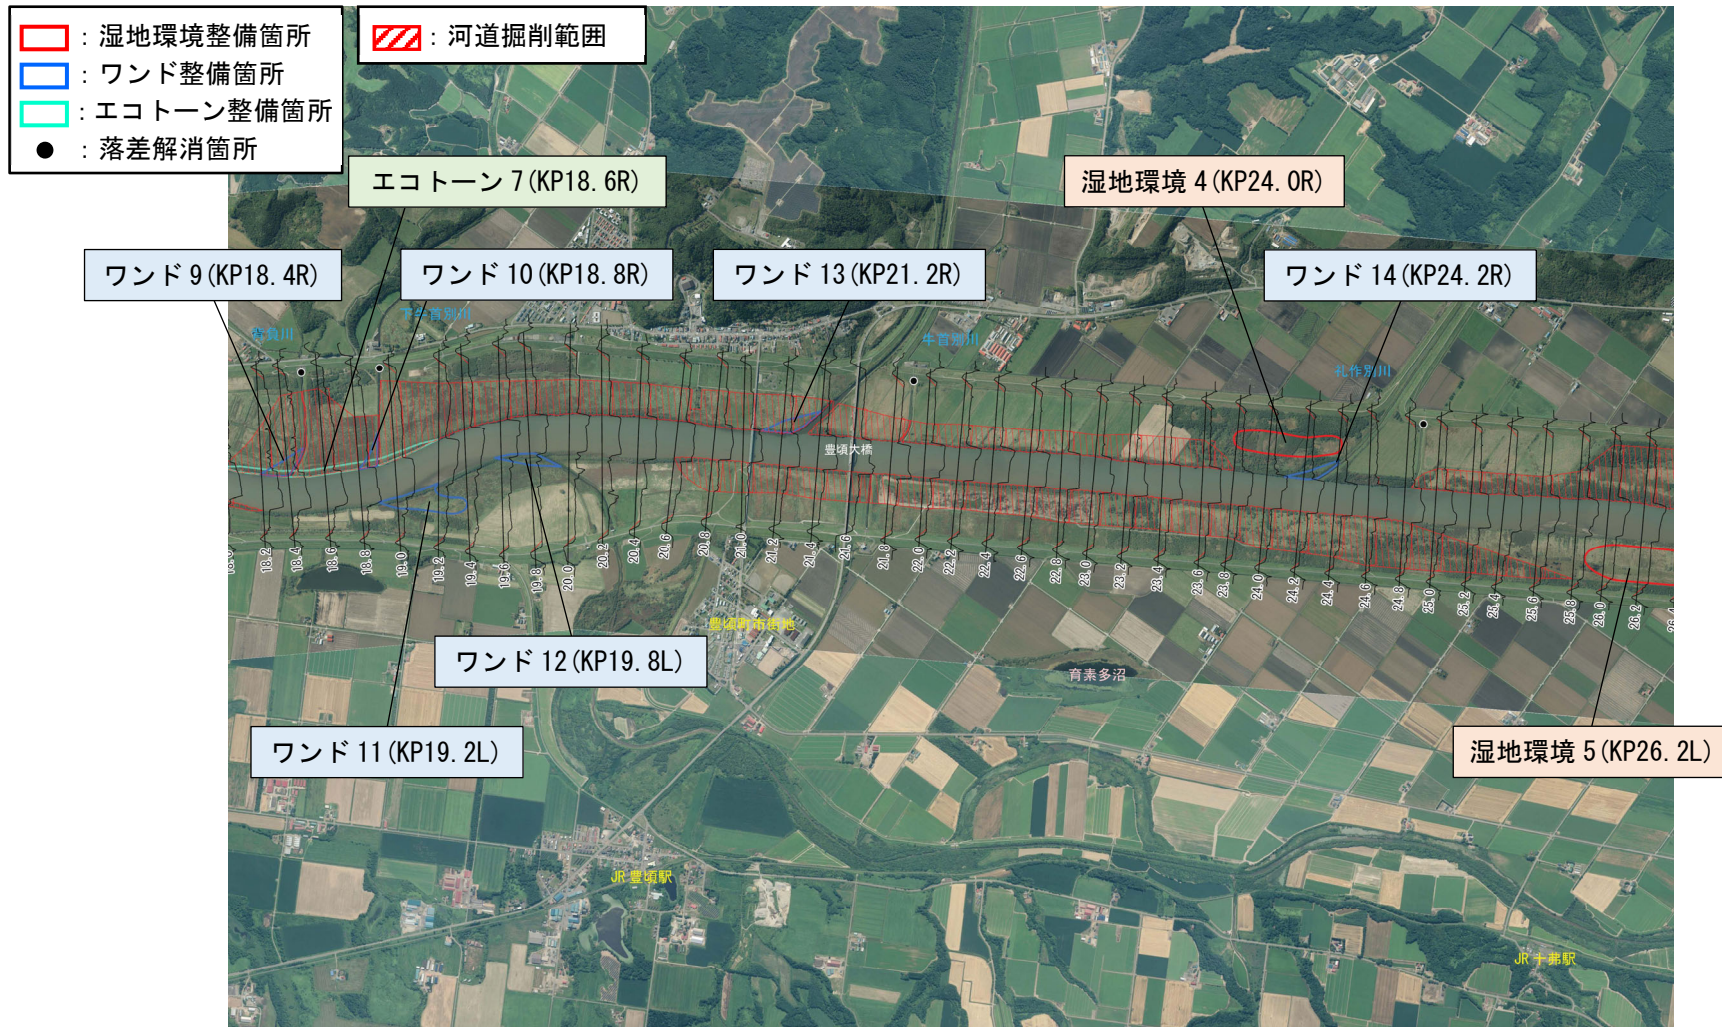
十勝川下流・中流部の配置計画平面図 (3/8)
